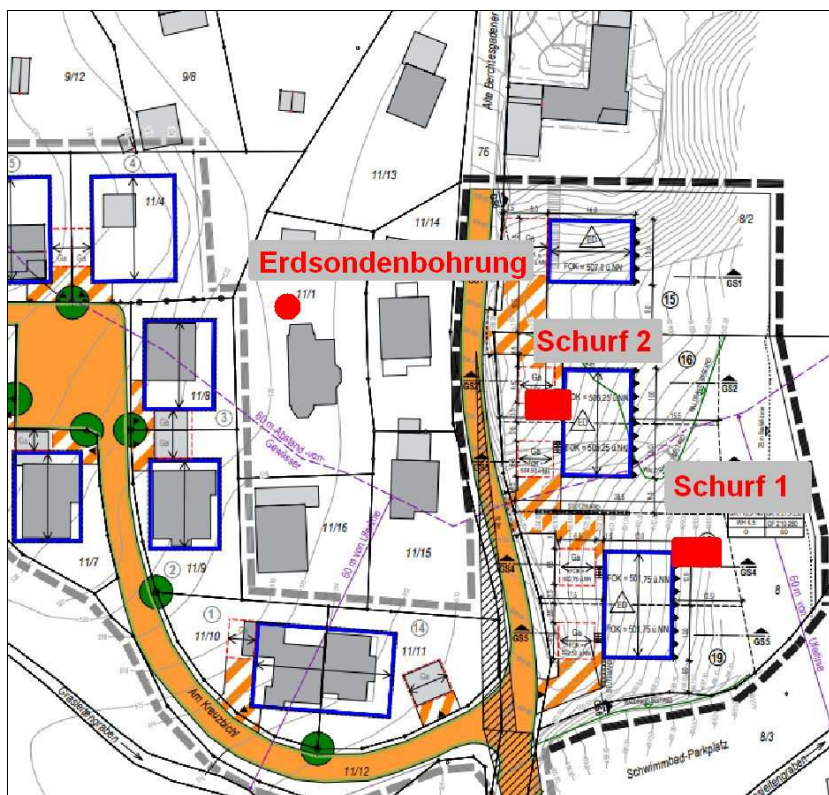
Lageplan Ausschnitt (ohne Maßstab) mit Lage der Schürfe und der Erdsondenbohrung in Bezug zum Baugebiet
